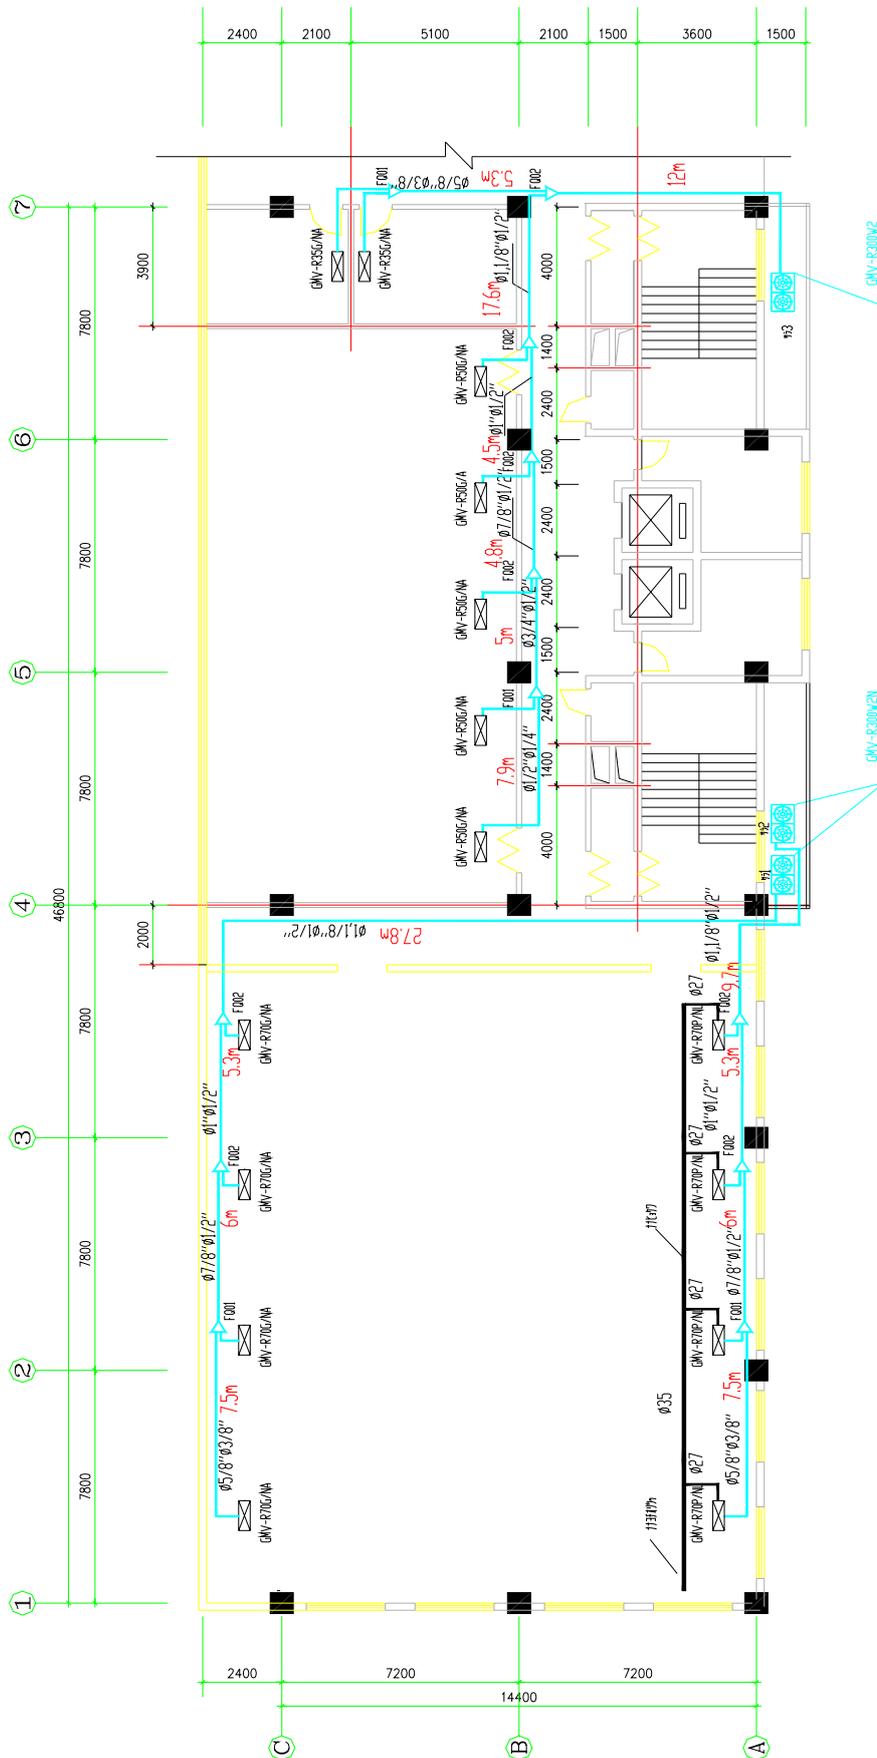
Схема размещения блоков и прокладки фреоновой трассы и дренажного трубопровода системы на плане здания
